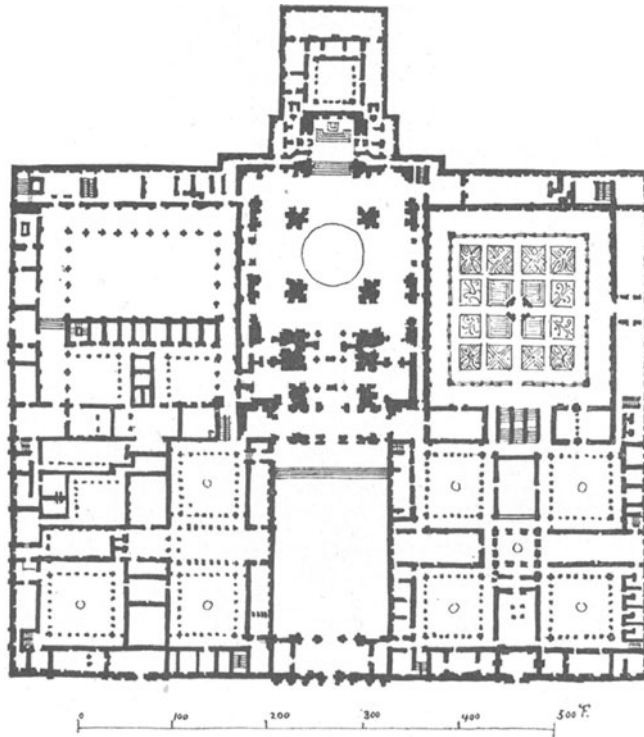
Escorial. Grundplan. (n. Ximenes.)
